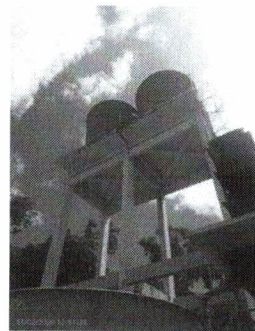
Conjunto de reservatórios em fibra em estrutura elevada
